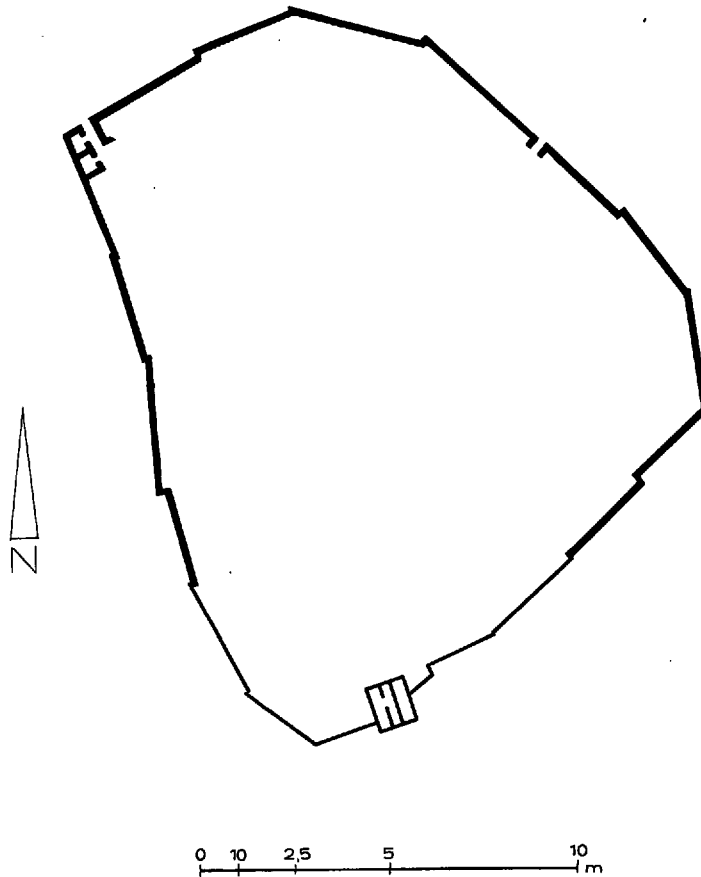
Ğidfir ibn Munayhir: plan de la muraille.
